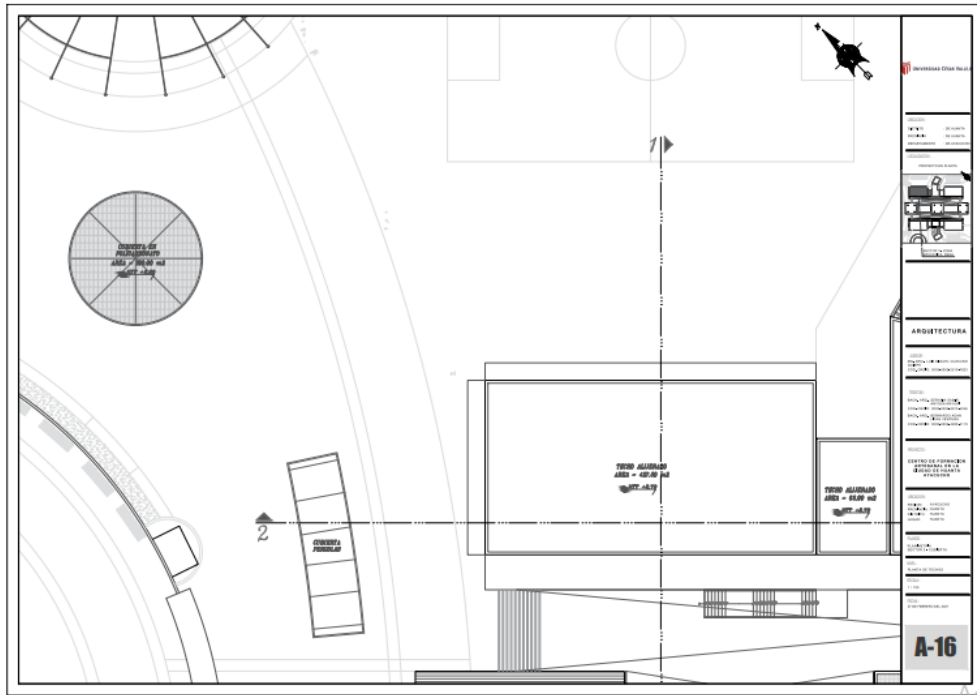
Planimetría de techos del sector 3. Escala 1/100.
